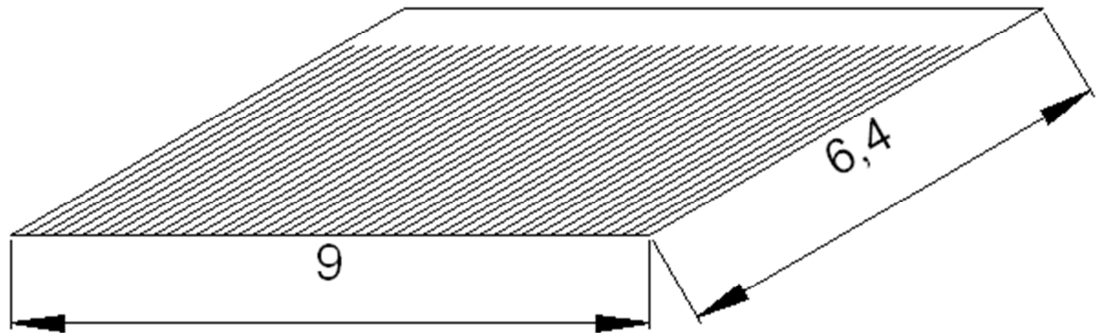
Perforaciones para el levante. (Unidad metro)
